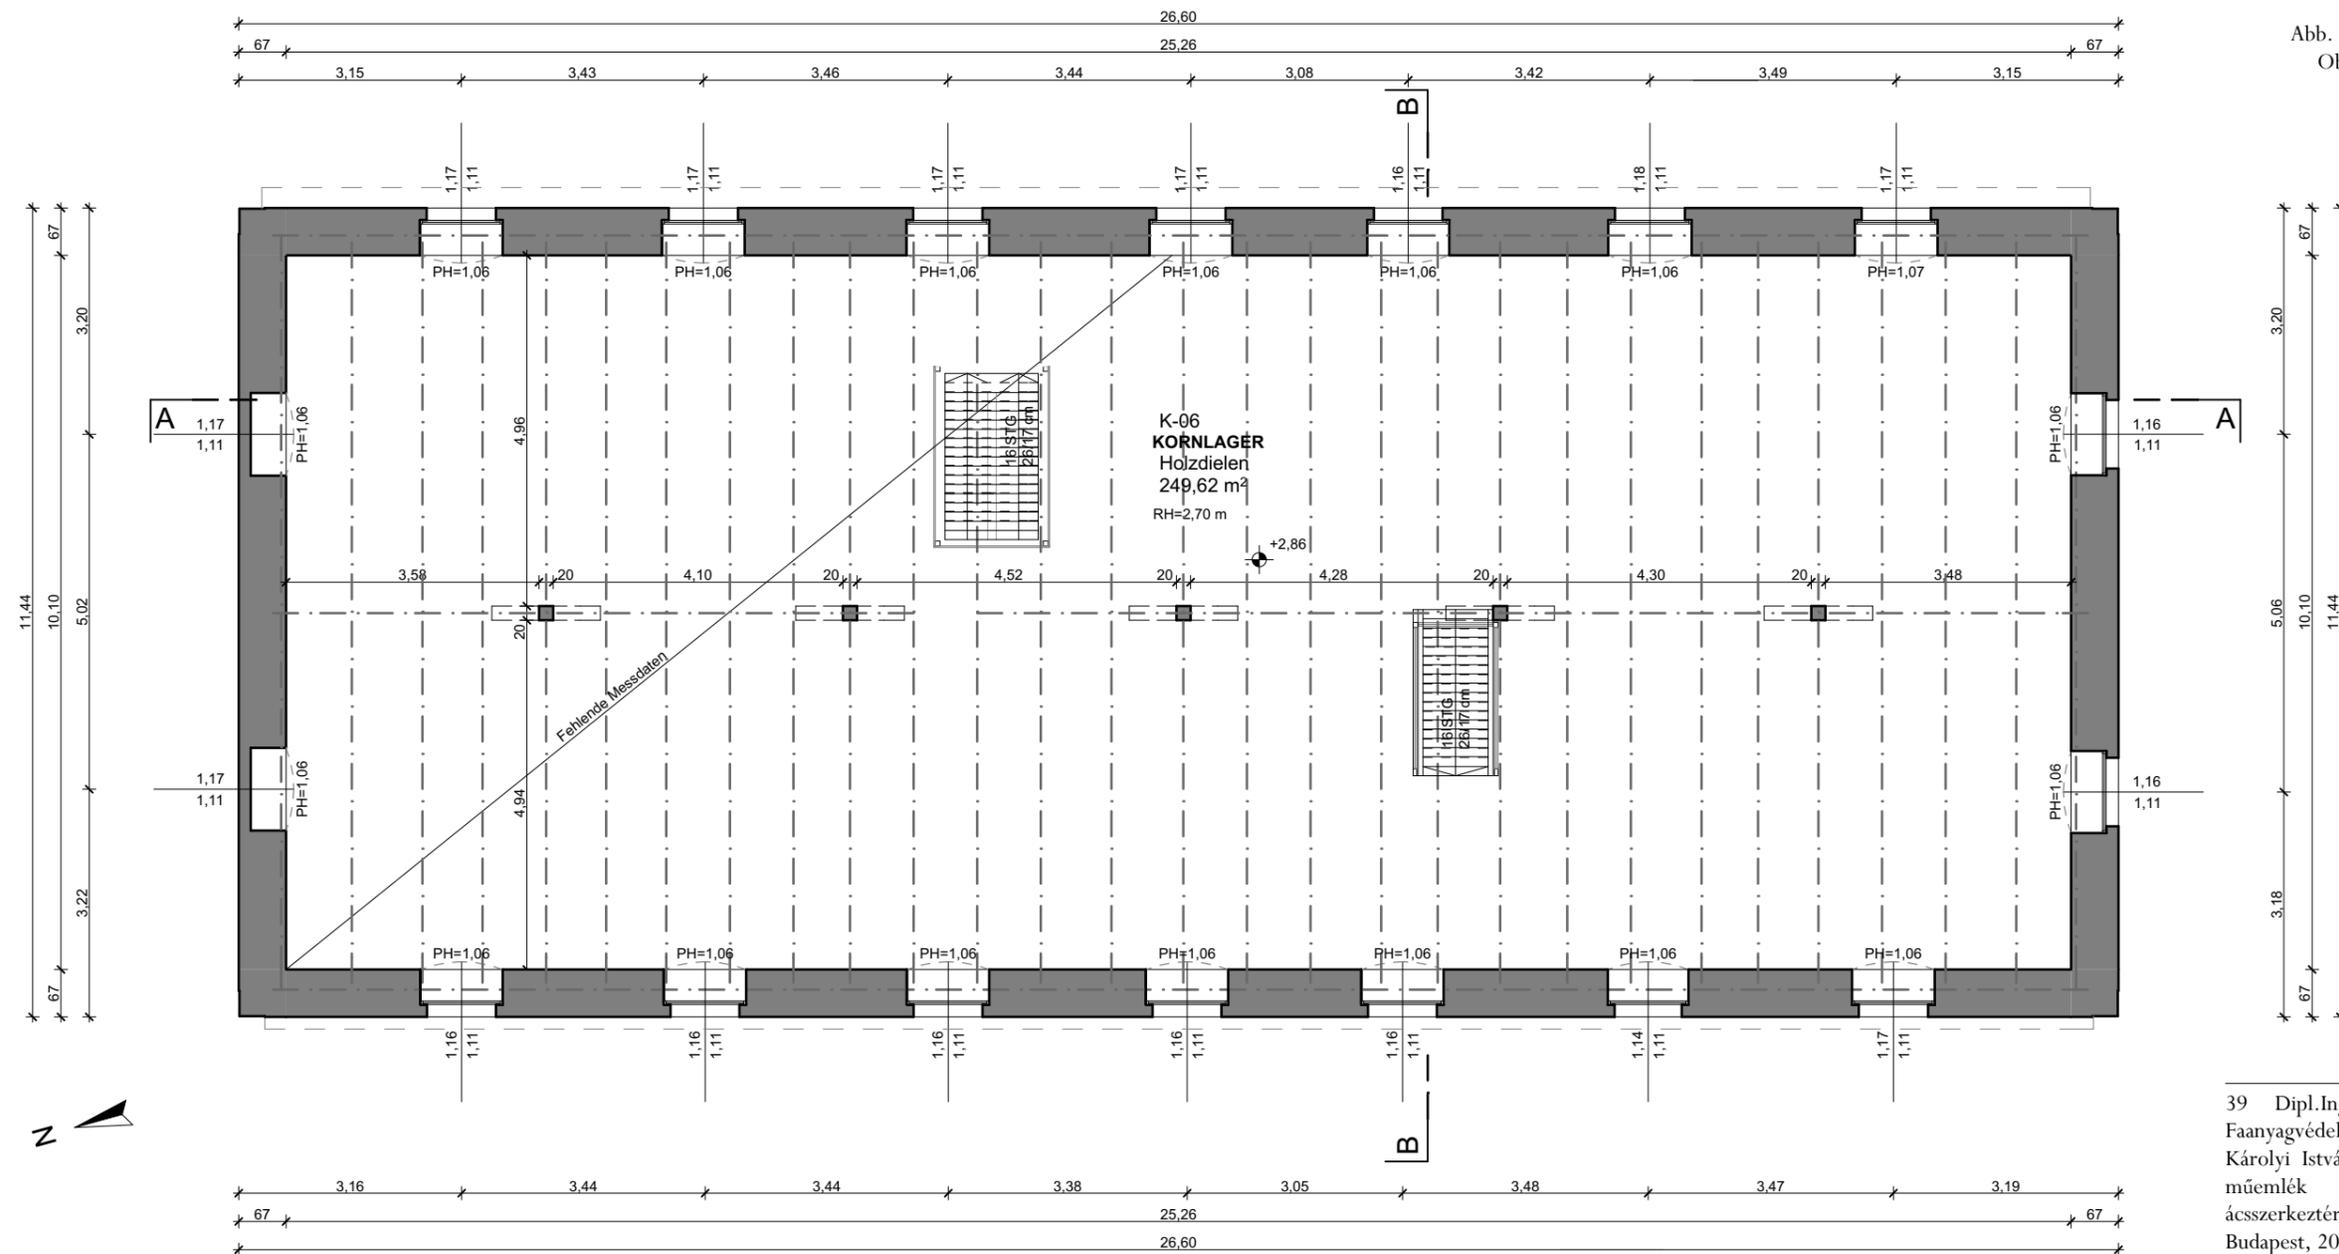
Bestandsplan: Grundriss Obergeschoss des Kornhauses M 1:100
